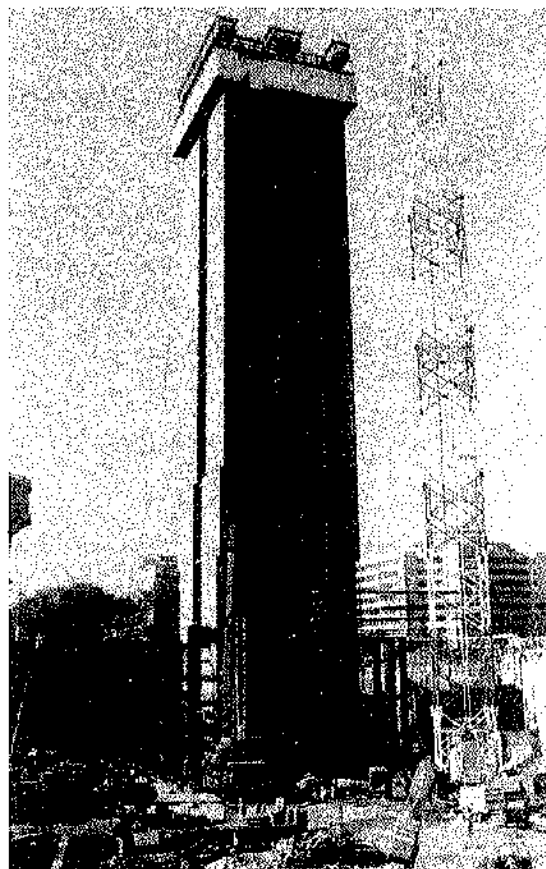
Núcleo de hormigón y estructura metálica sótanos.
